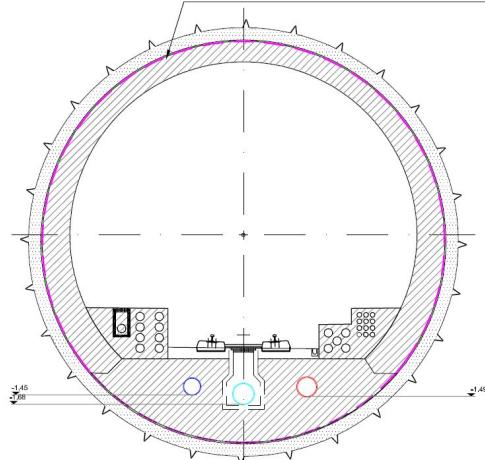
Impermeabilizzazione di tipo 3 per scavo con TBM aperta
